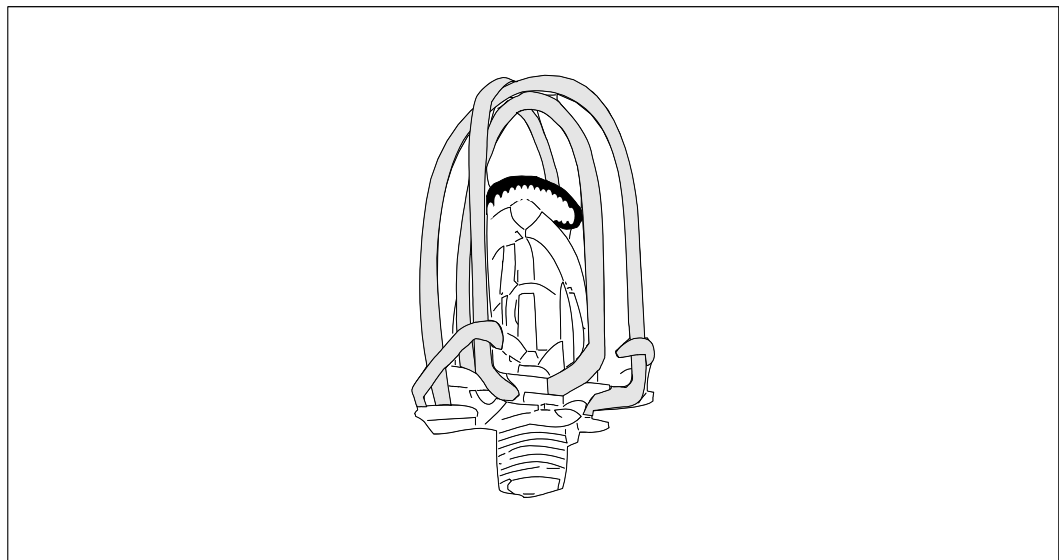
Exemple de dispositif de protection d'un sprinkleur
